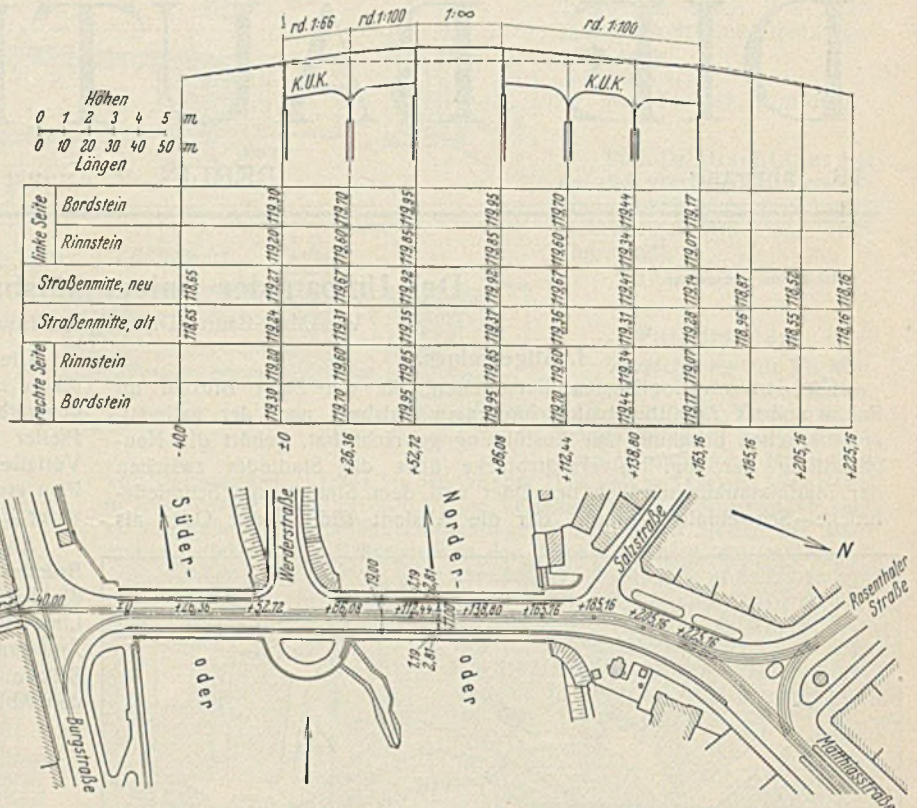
Längenschnitt und Grundrißanordnung des Brückenzuges nach dem Umbau.
